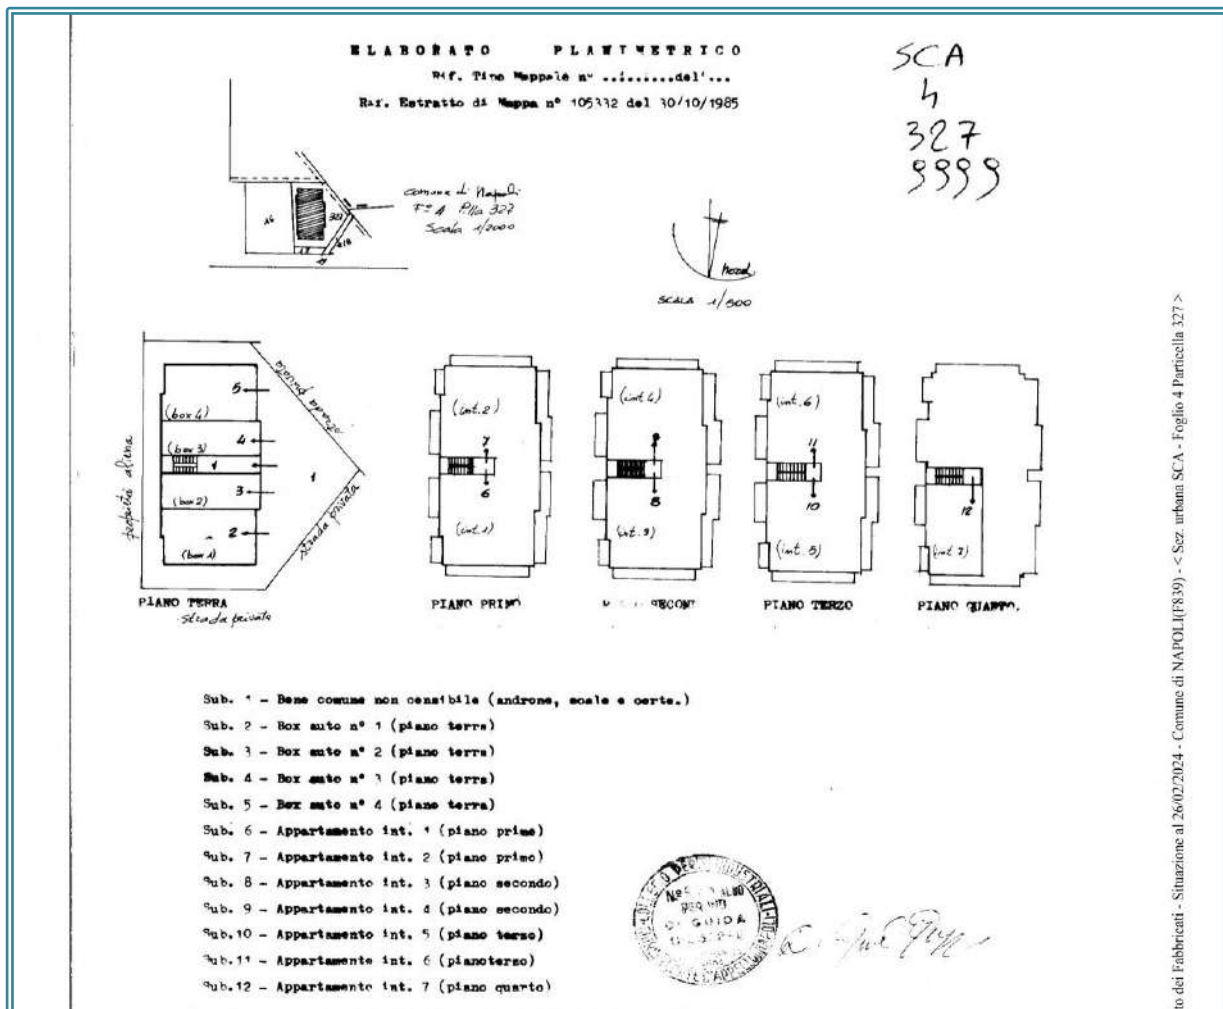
Elaborato planimetrico (TUTTI I LOTTI)
